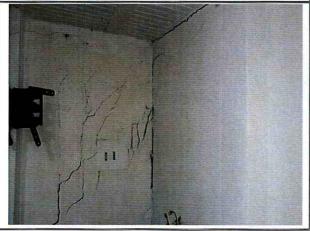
y 8. Condiciones muros divisorios y perimetrales vivienda emplazada en Predio 2. Fotografía tomada el 17/04/2018
